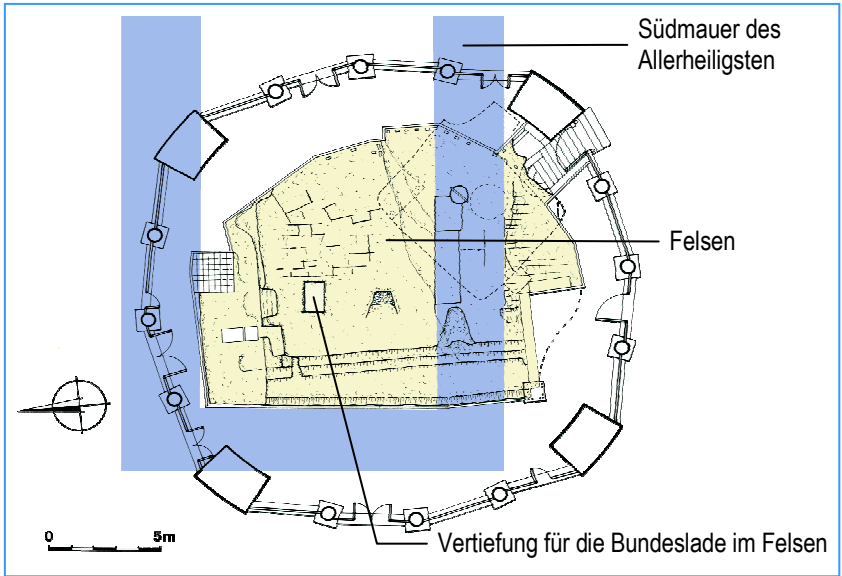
Grundriss der Omar-Moschee mit dem Grundriss der Mauern des Allerheiligsten²⁶⁵
